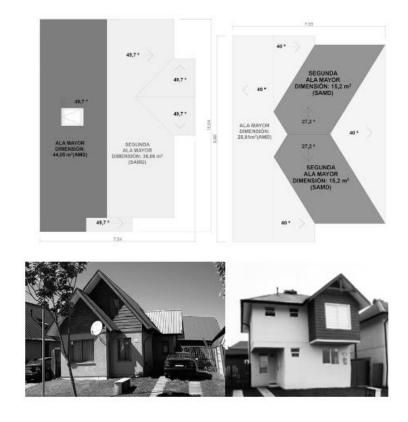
a)b) planimetrías techumbres; c) y d) fotografías viviendas del área de estudio. FUENTE: Zalamea León, E. (2016
